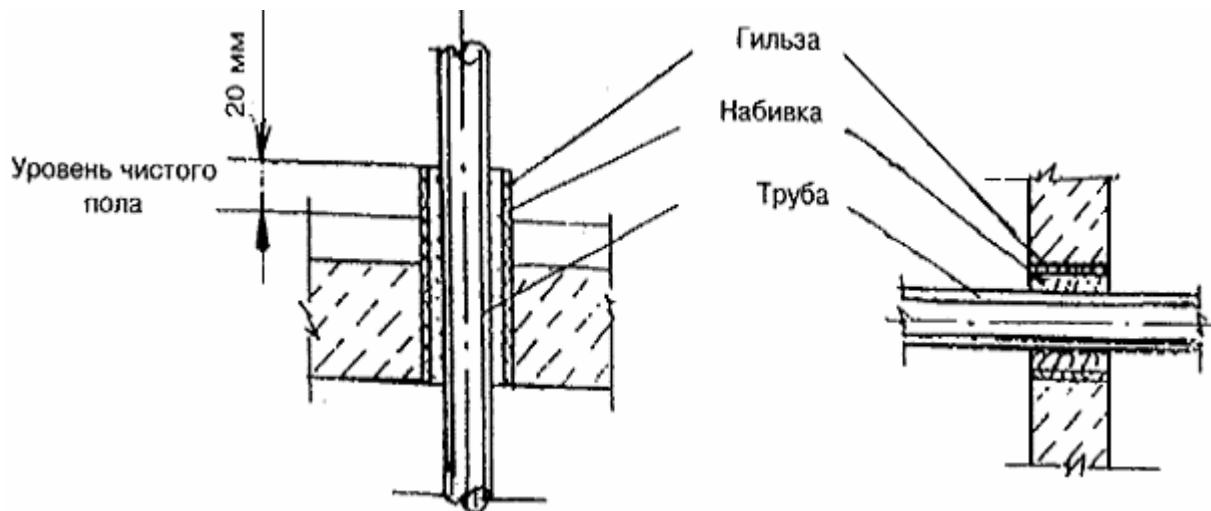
Установка гильзы для прокладки труб в стенах и перекрытиях
